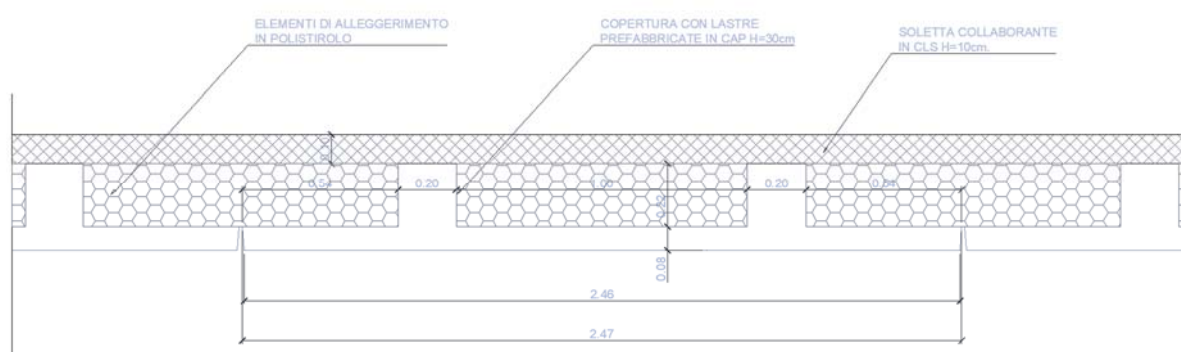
SEZIONE TIPO SOLAIO DI COPERTURA
